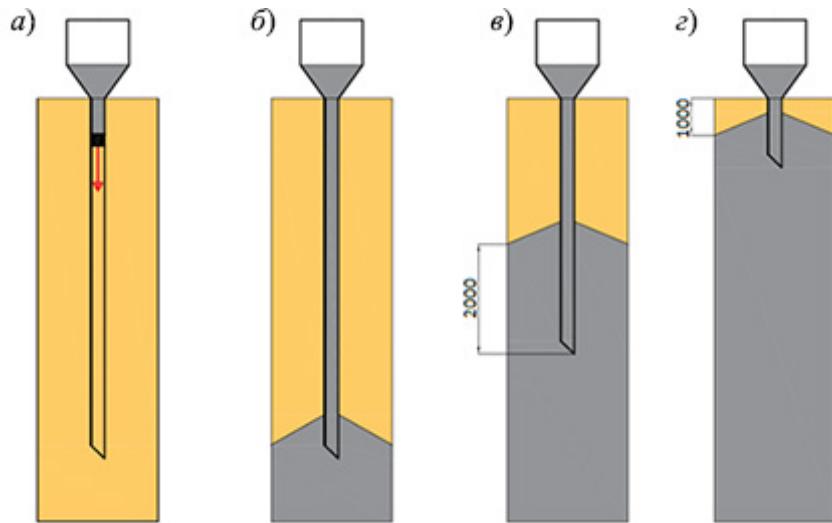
Этапы бетонирования траншейной стены в грунте:
